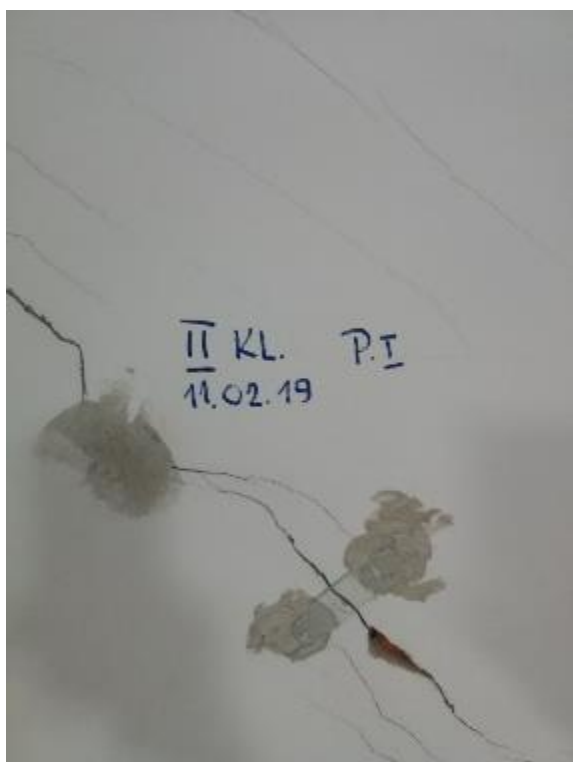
Przykładowe uszkodzenia sufitów żelbetowych
